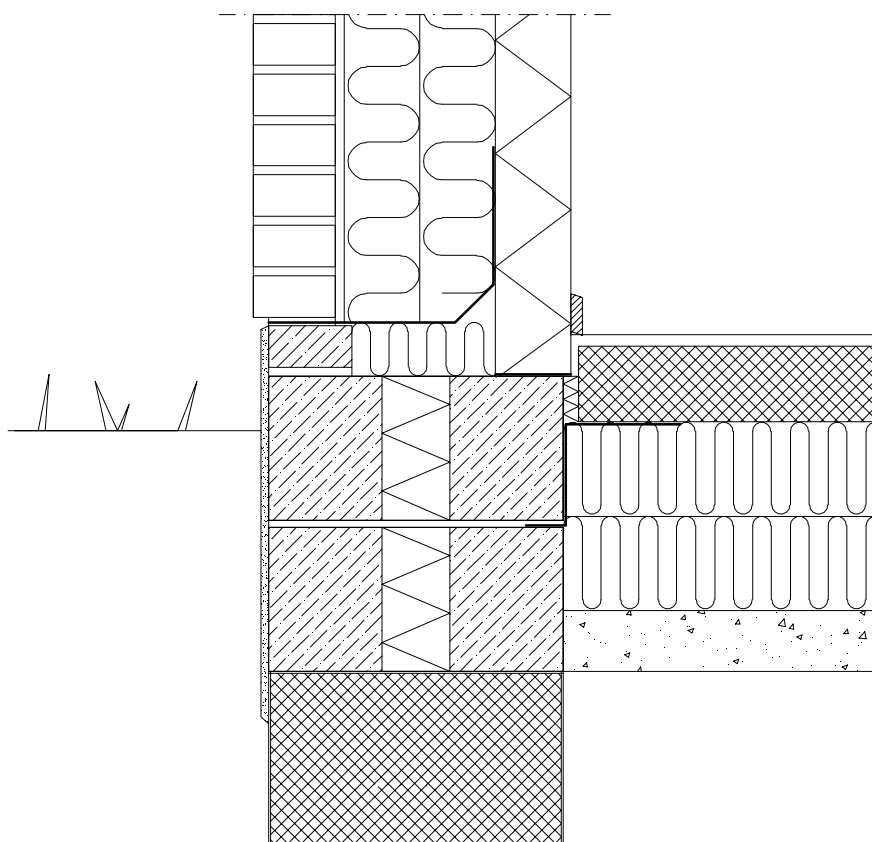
Hus A. Skalmurede porebetonelementer. Facader.
